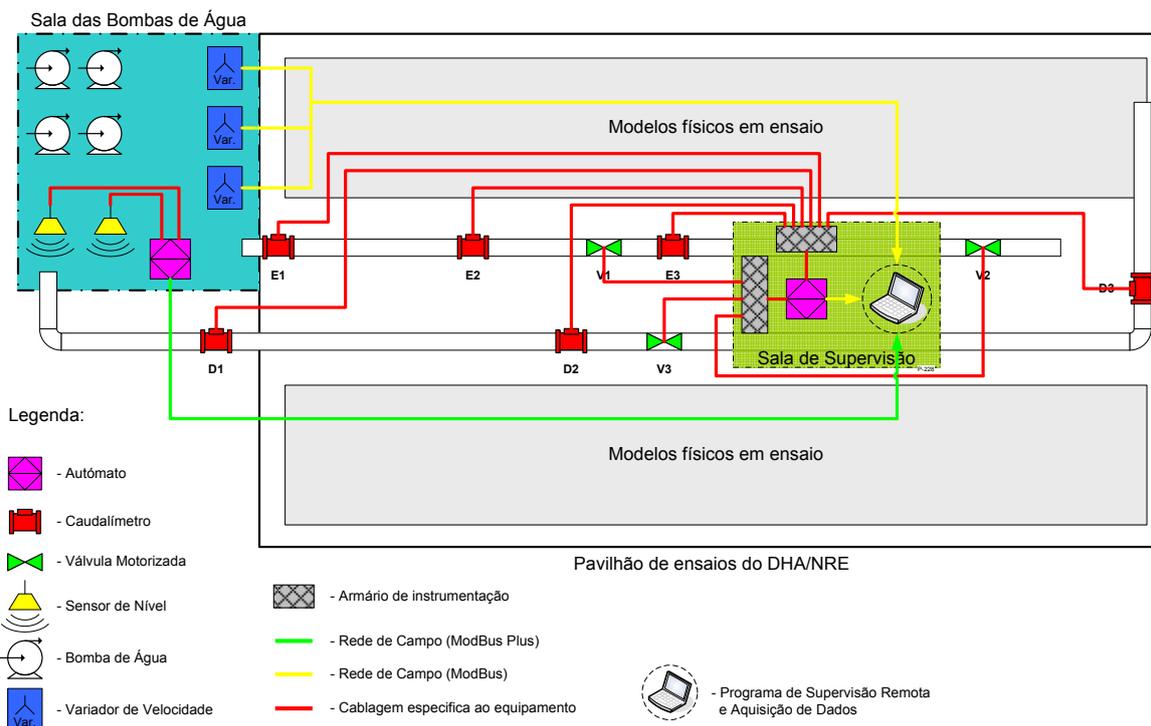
Esquema simplificado da planta de instalação do equipamento e cablagens.
